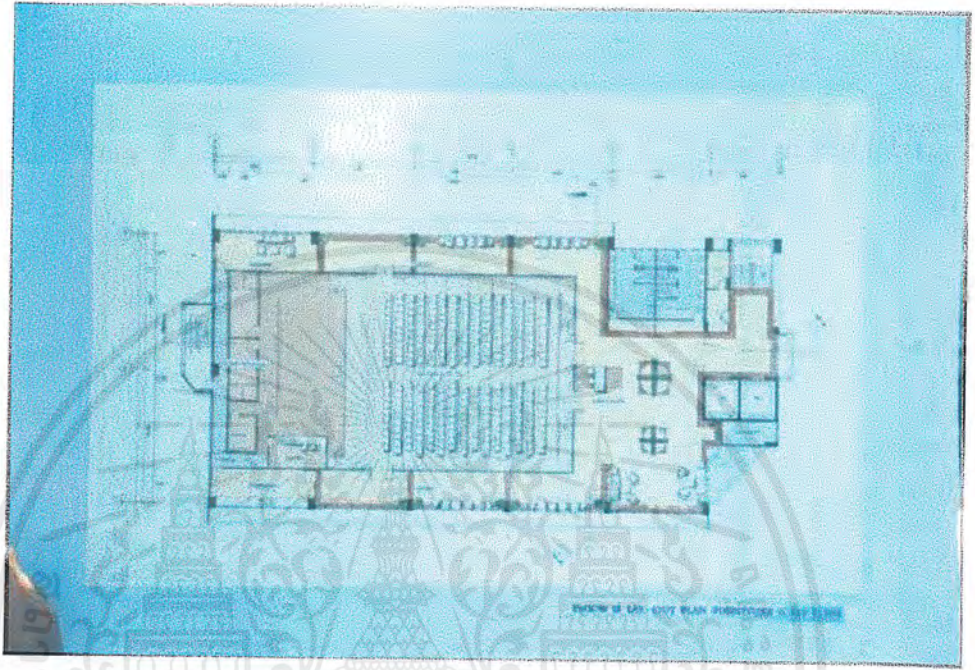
แสดง FLOOR 4 LAY - OUT FURNITURE PLAN
